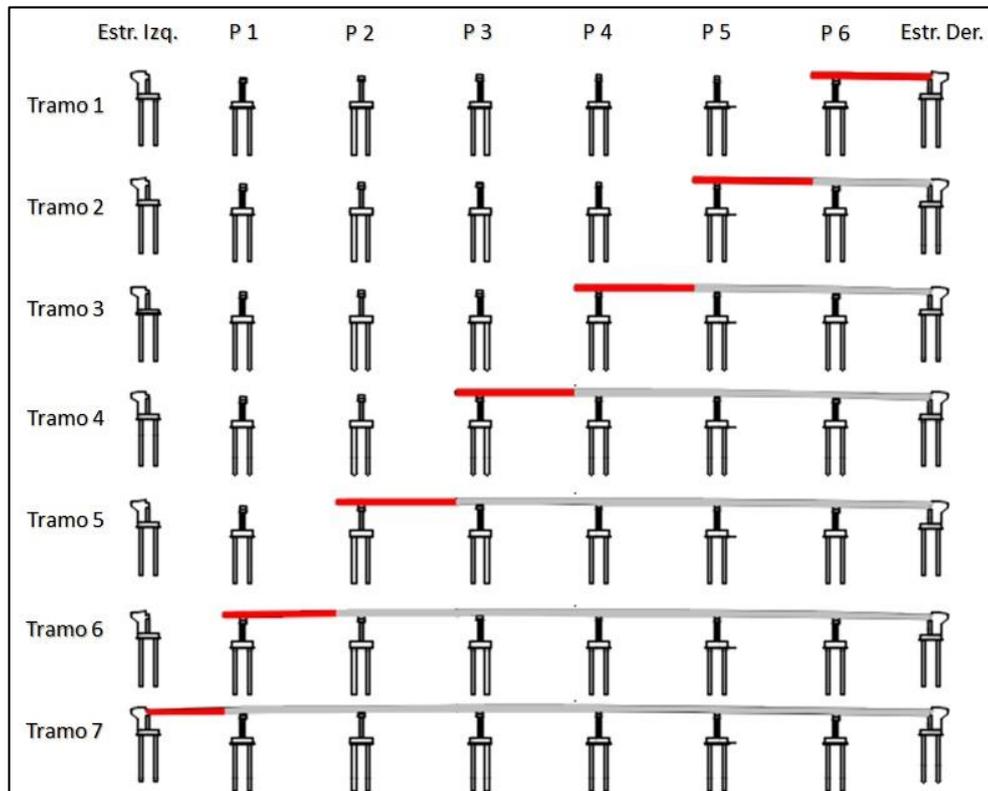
Tramos en el proceso constructivo de la viga cajón.
